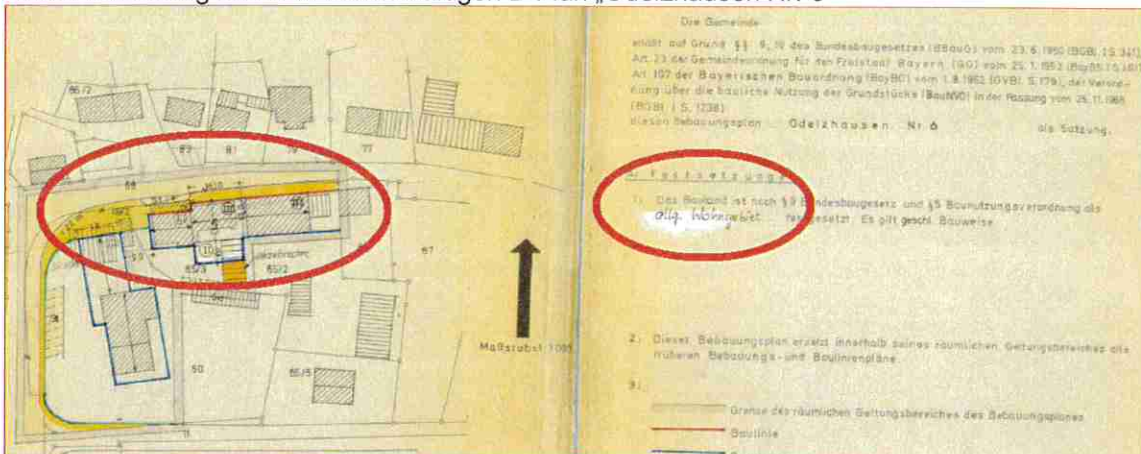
Teilauszug aus dem rechtskräftigen B-Plan „1. Änderung Flurstück 43
